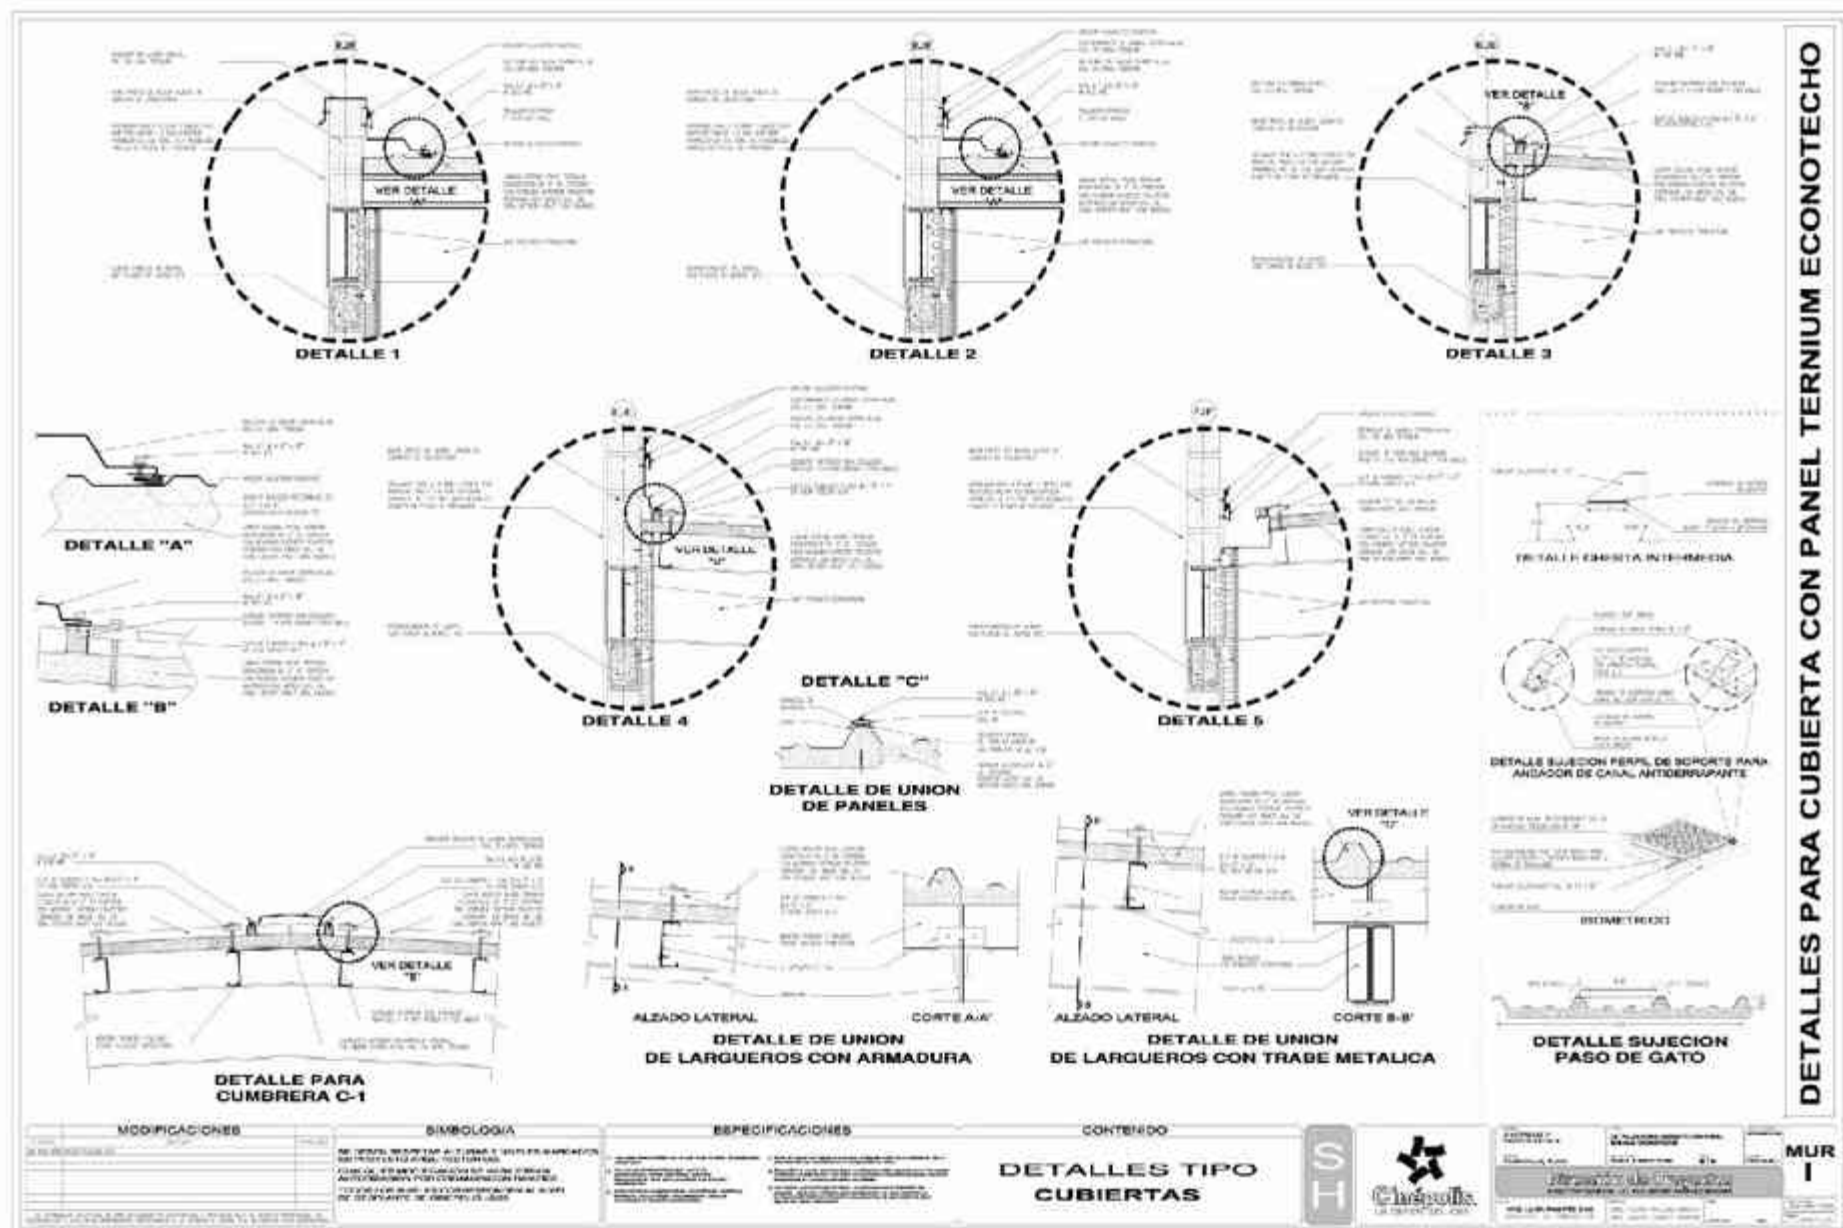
MUR-I Detalles para cubierta con panel ternium econotecho
